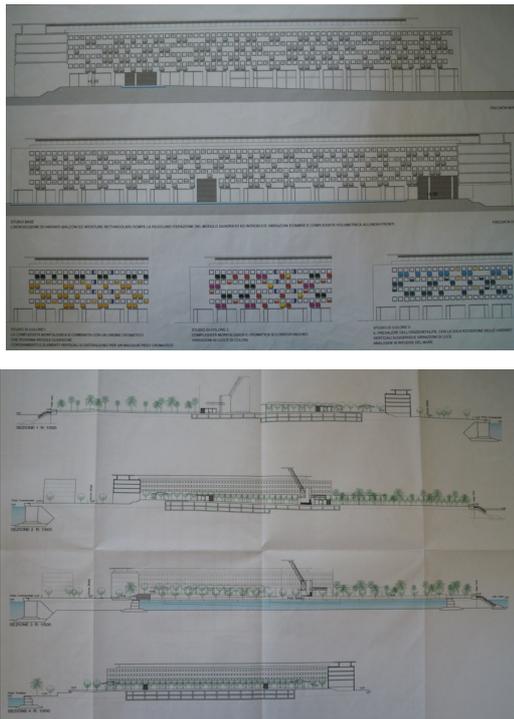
Progetto urbanistico e di massima del Porto di Santa Teresa, O. Bohigas, terza ipotesi, 1999-2000; Sezione della piazza e bozza dei prospetti degli edifici con studio cromatico delle facciate.
